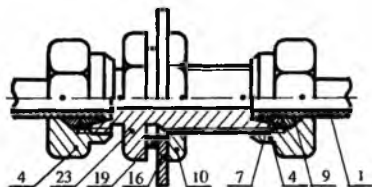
Р2.2. Ввод в коробку, щит, пульт, станин, шкаф металлической трубы
